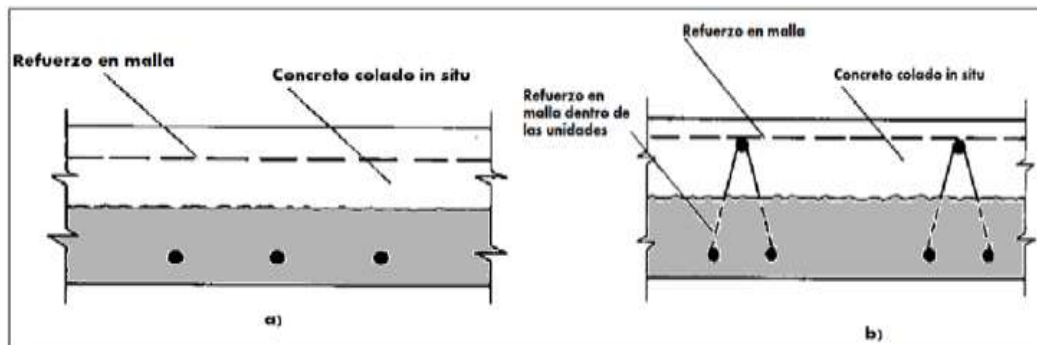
a) Losa solida compuesta en la figura b) el acero sobresale.
